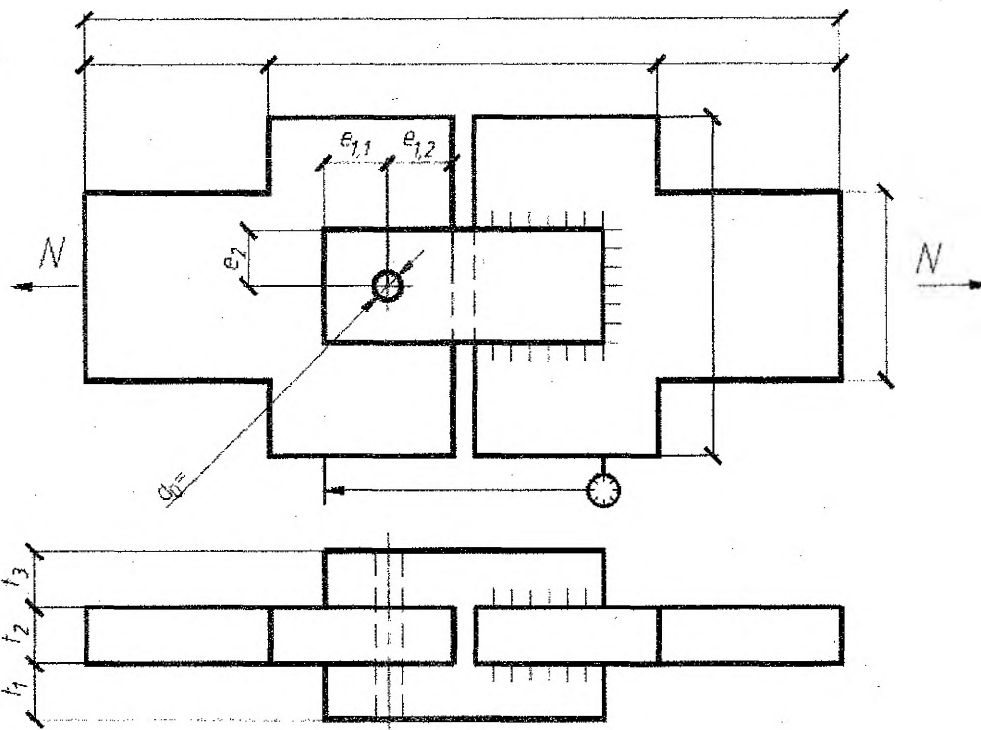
Эскиз приспособления для испытания болтовых соединений
